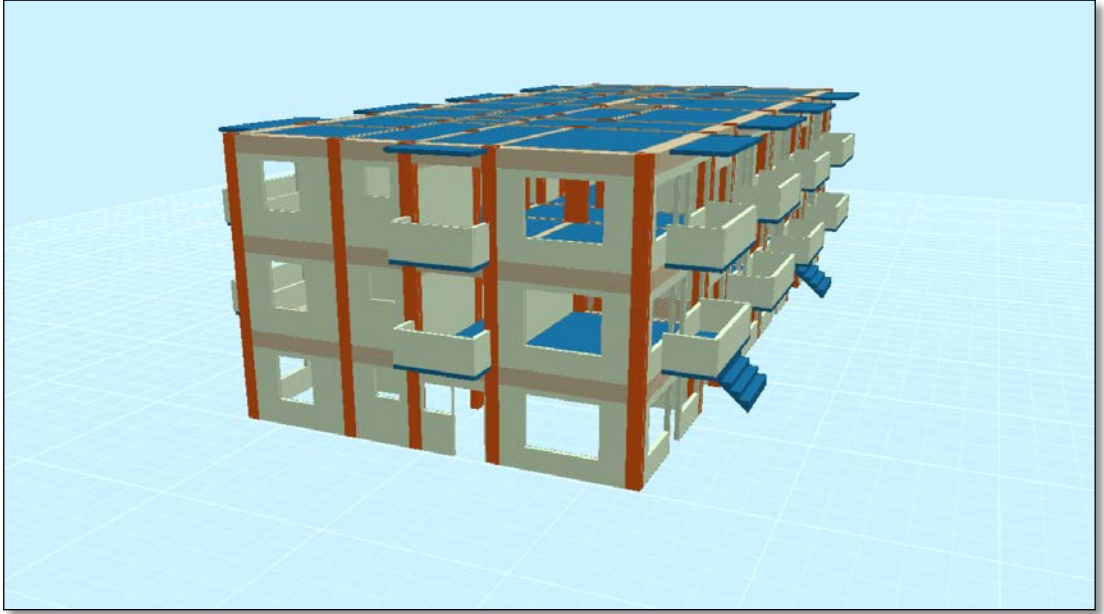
’de görüldüğü üzere döşemeler de tamamlanmıştır. Programda 2 boyutlu çizim yapılırken arka planda ve izlenebilir 3D ekranında 3 boyutlu yapı oluşmaktadır. Kat kopyalama seçeneğiyle oluşturulan plan, yapı kaç katlı ise üst katlara kopyalanır. Üst katlarda değişiklikler olması durumunda her kata gidilerek gerekli düzenlemeler yapılır. Merdiven modellemesi de yapı elemanları sekmesindeki alt ok ile sağlanır.
